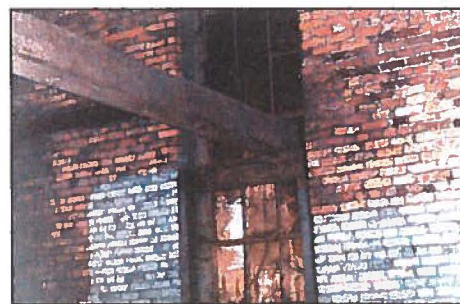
, Support inapproprié de la poutre intermédiaire sur un linteau temporaire de fenêtre;
